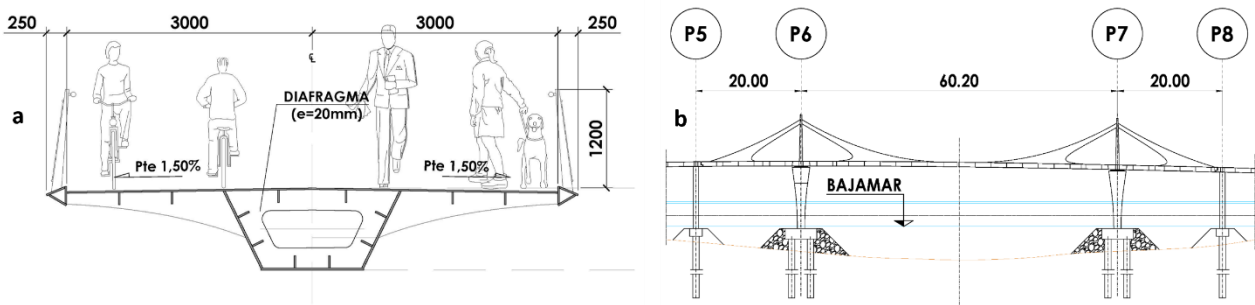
a) Sección tipo, b) conjunto tramo móvil
